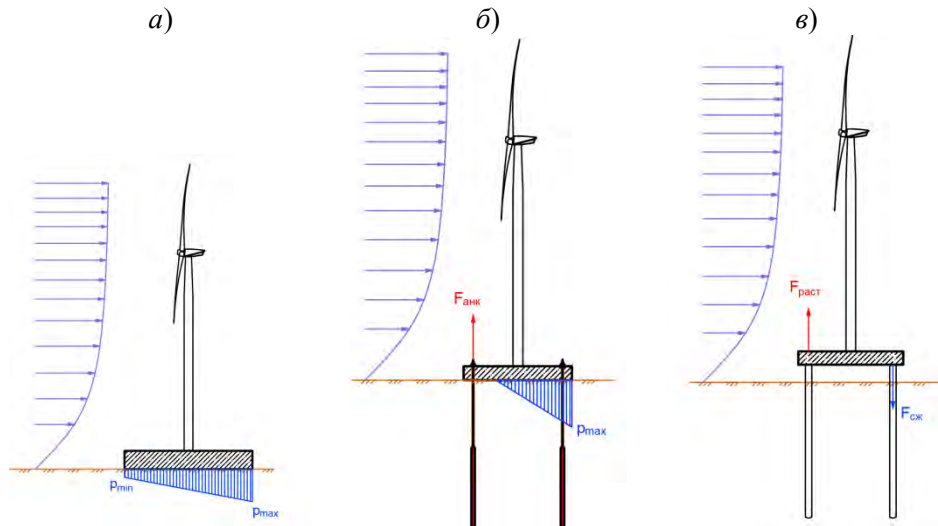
Схемы перераспределения нагрузок фундаментами различного типа: а – гравитационный фундамент; б – анкерный фундамент; в – свайный фундамент
